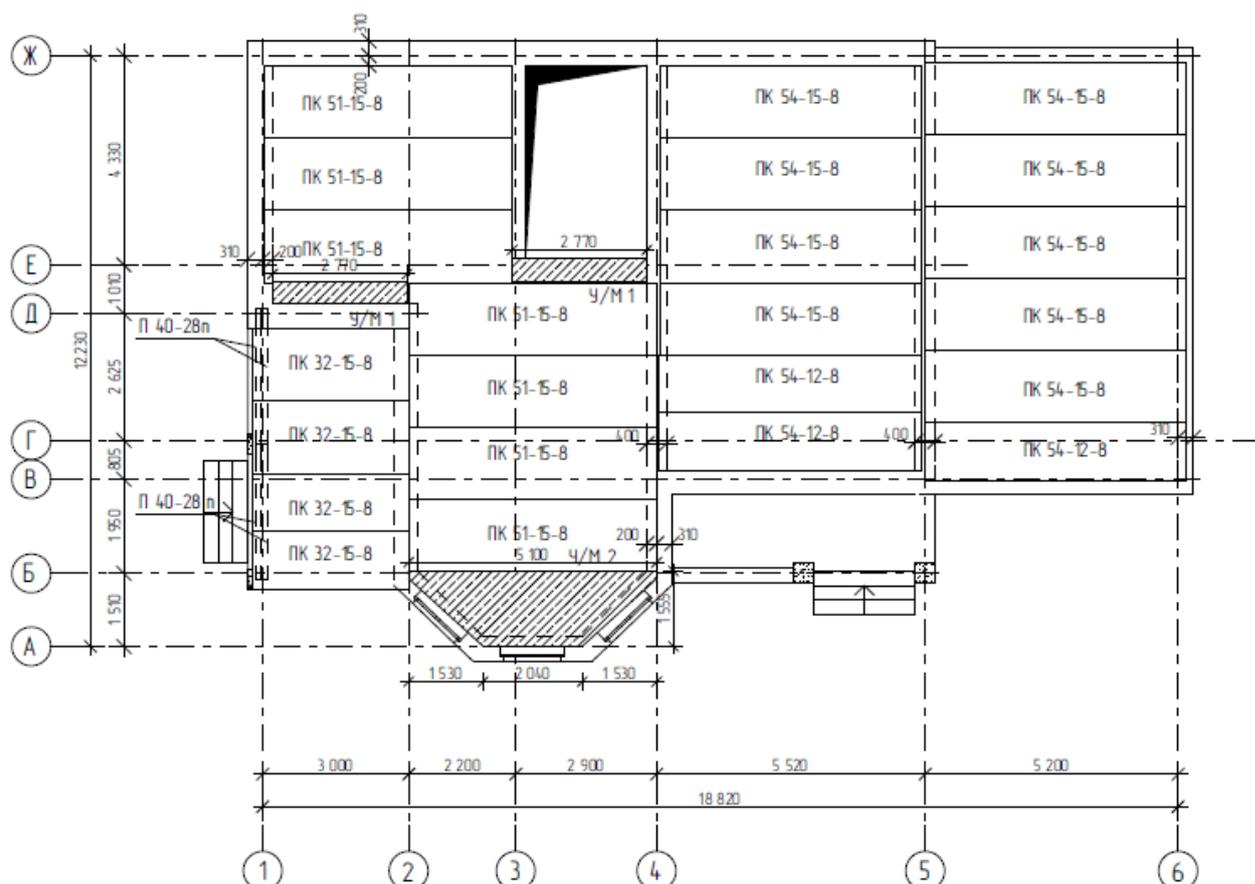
Схема раскладки многопустотных плит перекрытия
